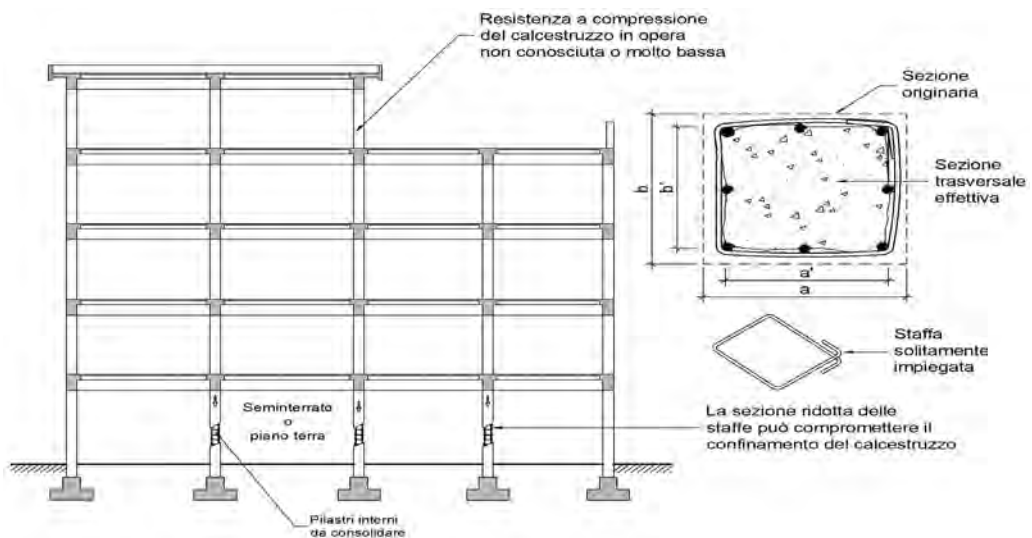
Riduzione della sezione trasversale dei pilastri interni a livello di piano terra o seminterrato che in futuro potrebbero compromettere la stabilità dell'edificio anche per soli carichi verticali
